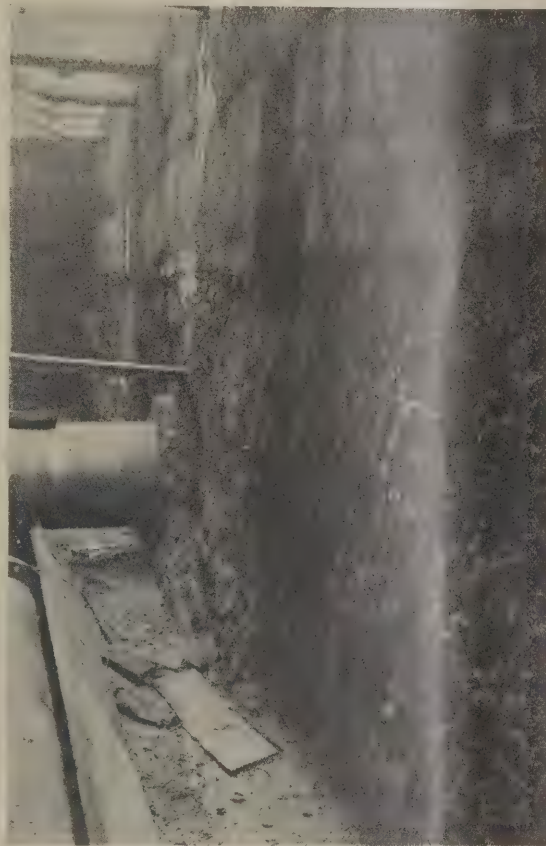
Lichtschachtwand, durch Säure angegriffen.
